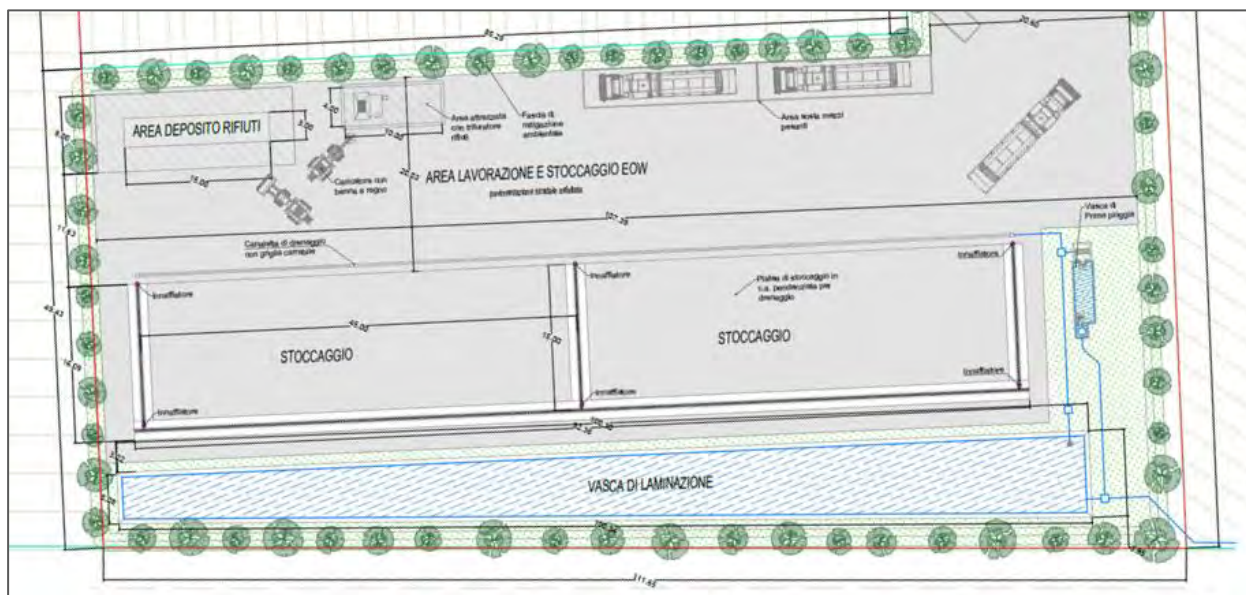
Stralcio Planimetria generale (SPA 01.01) con dettaglio area di lavorazione
